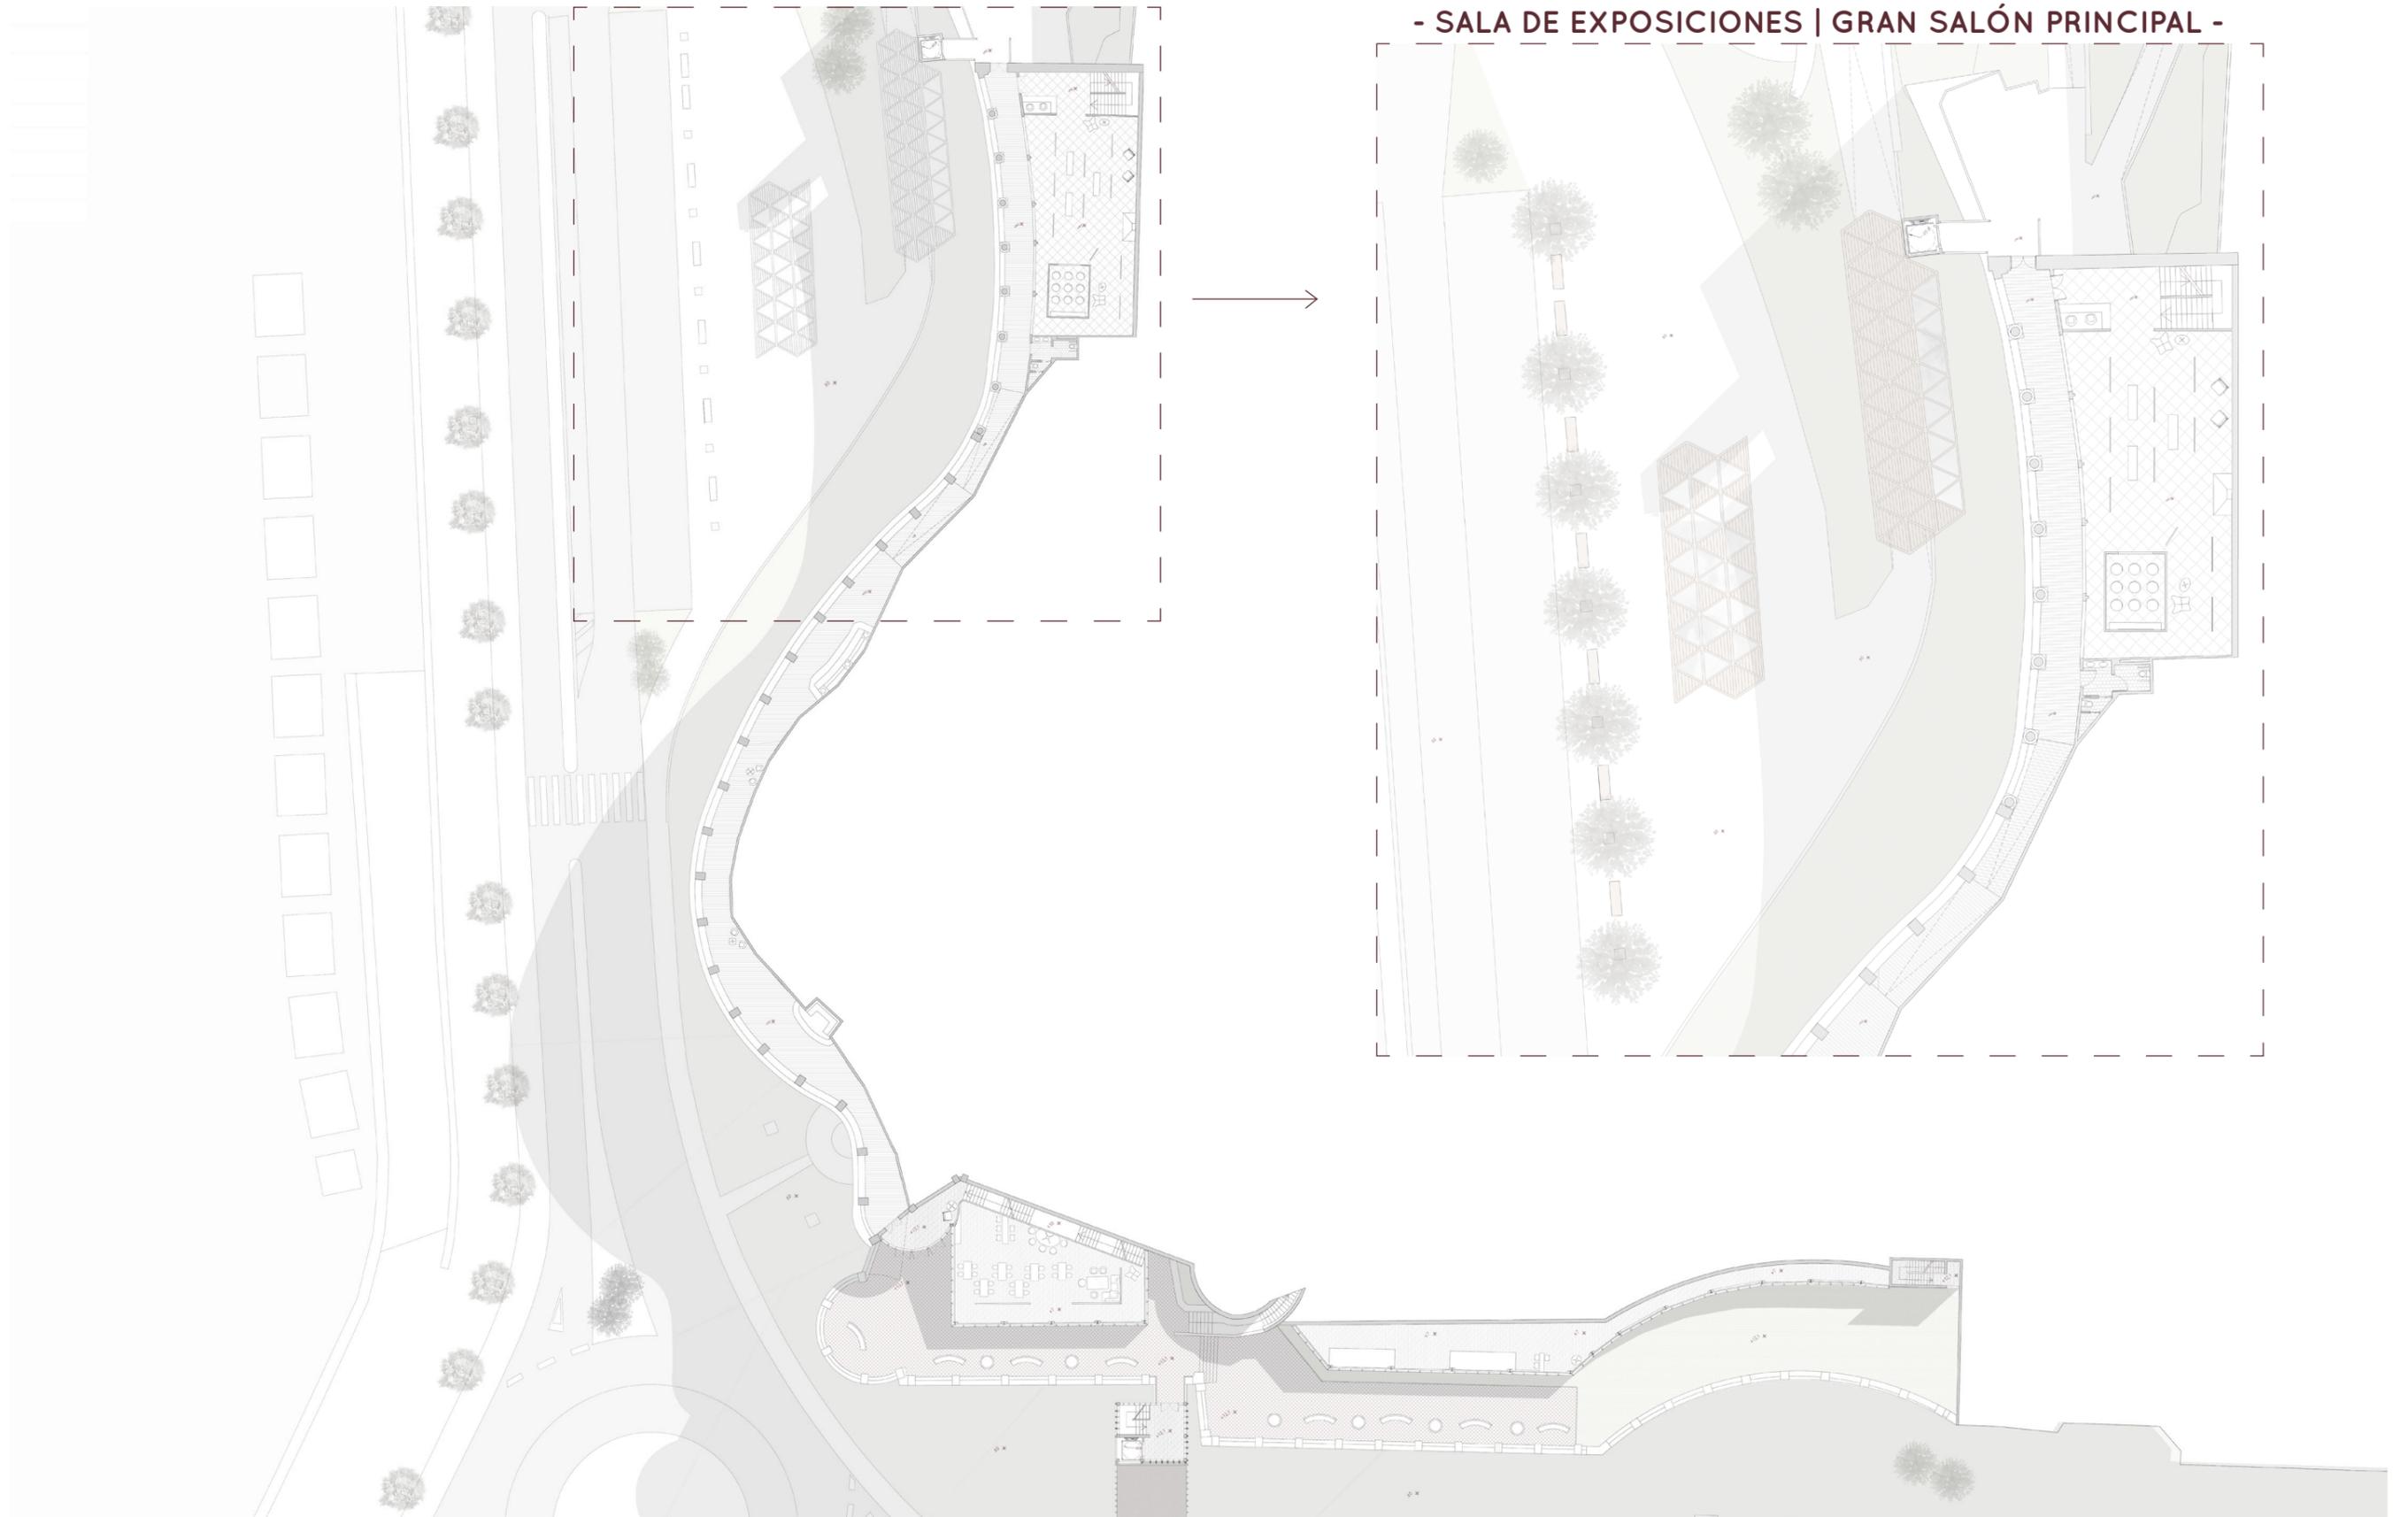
Planta general de conexión entre galerías y detalle de salón de exposición y estructuras con la exposición sobre el patrimonio.
